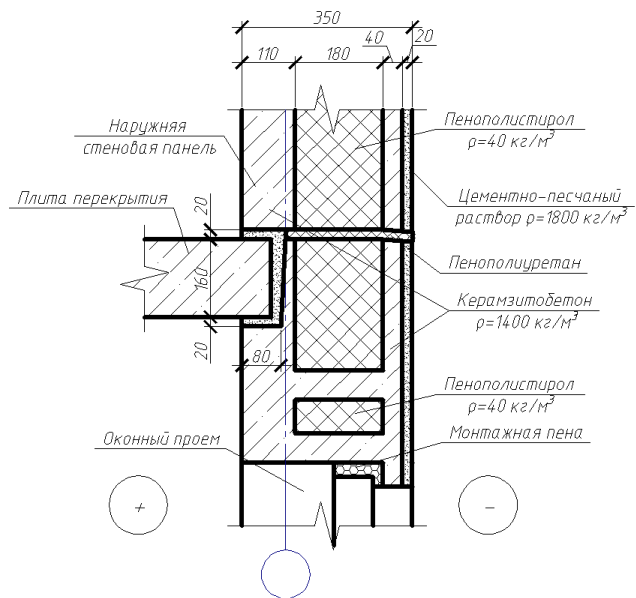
Узел примыкания наружного ограждения к внутренней железобетонной стене и плите перекрытия. Предлагаемое решение
